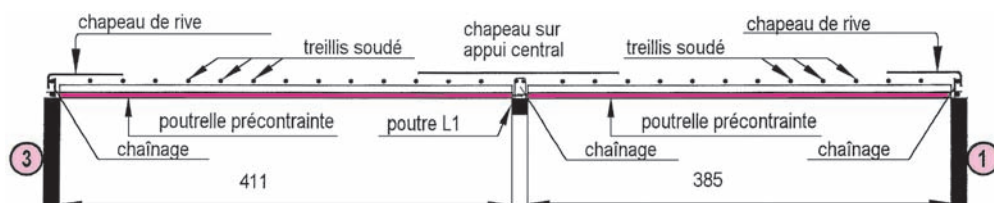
Préconisations du plan de pose : étaieiment, poutrelles, aciers en chapeaux, etc.
